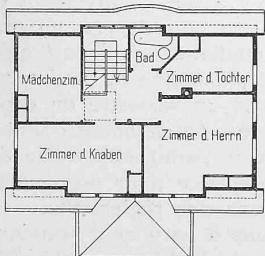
Grundriss vom Obergeschoss des Sommerhauses «Rotenus». — 1:400.
